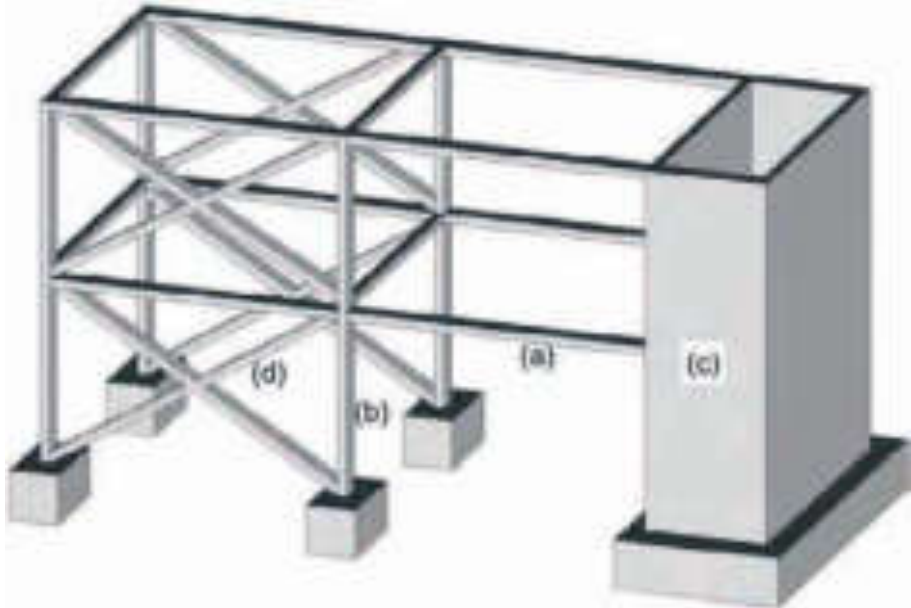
Struttura in elevazione verticale a telaio: travi (a), pilastri (b), nucleo controventante (c), irrigidimento/controventamento (d).
